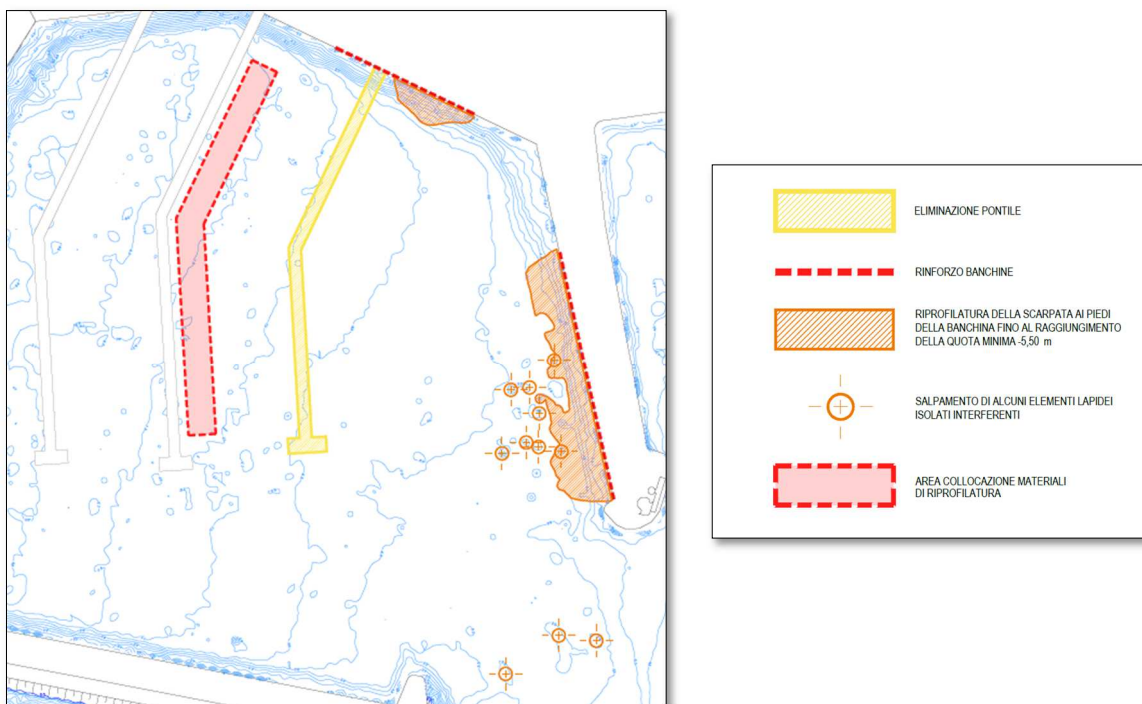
Stralcio elaborato grafico "V3.E-D-05-00 – Planimetria di raffronto"
